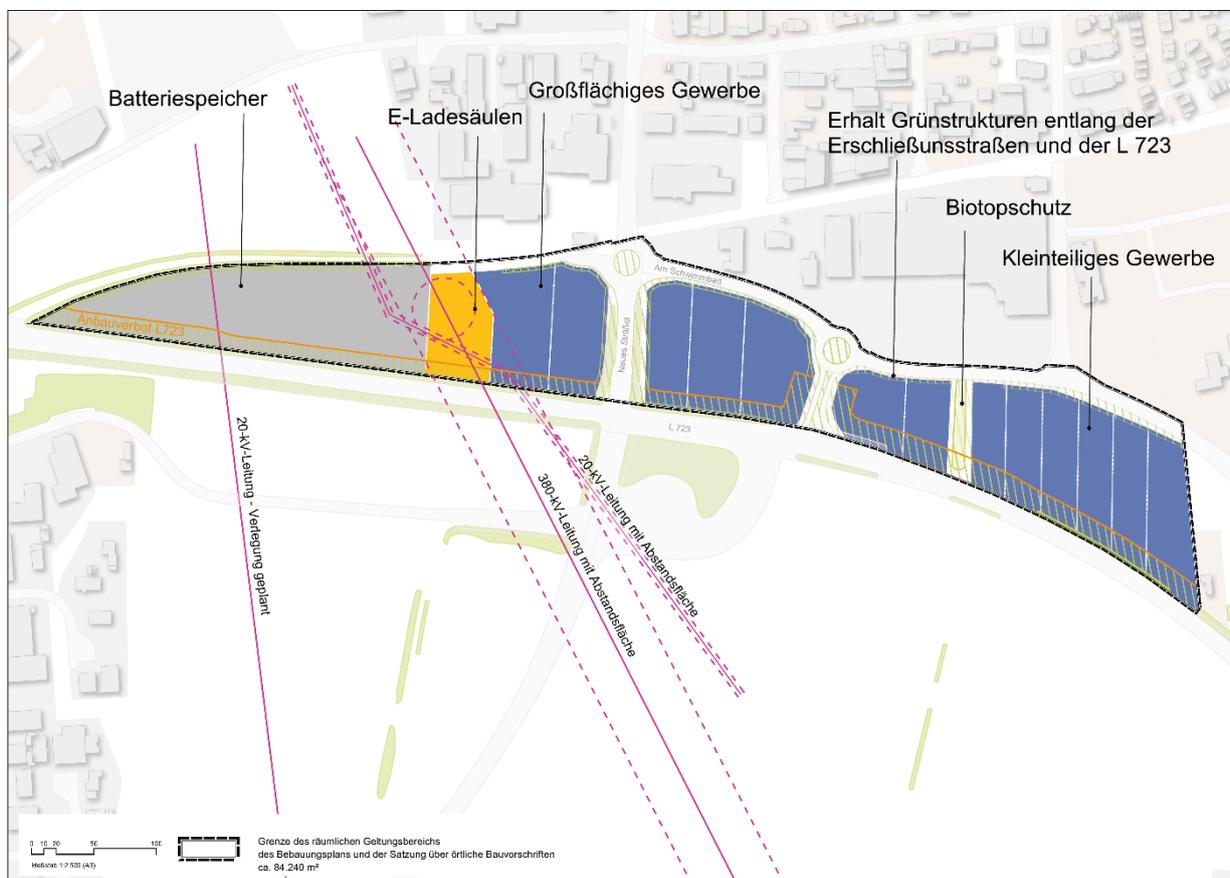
Parzellierungsvariante (Stand: 26.08.2025)
